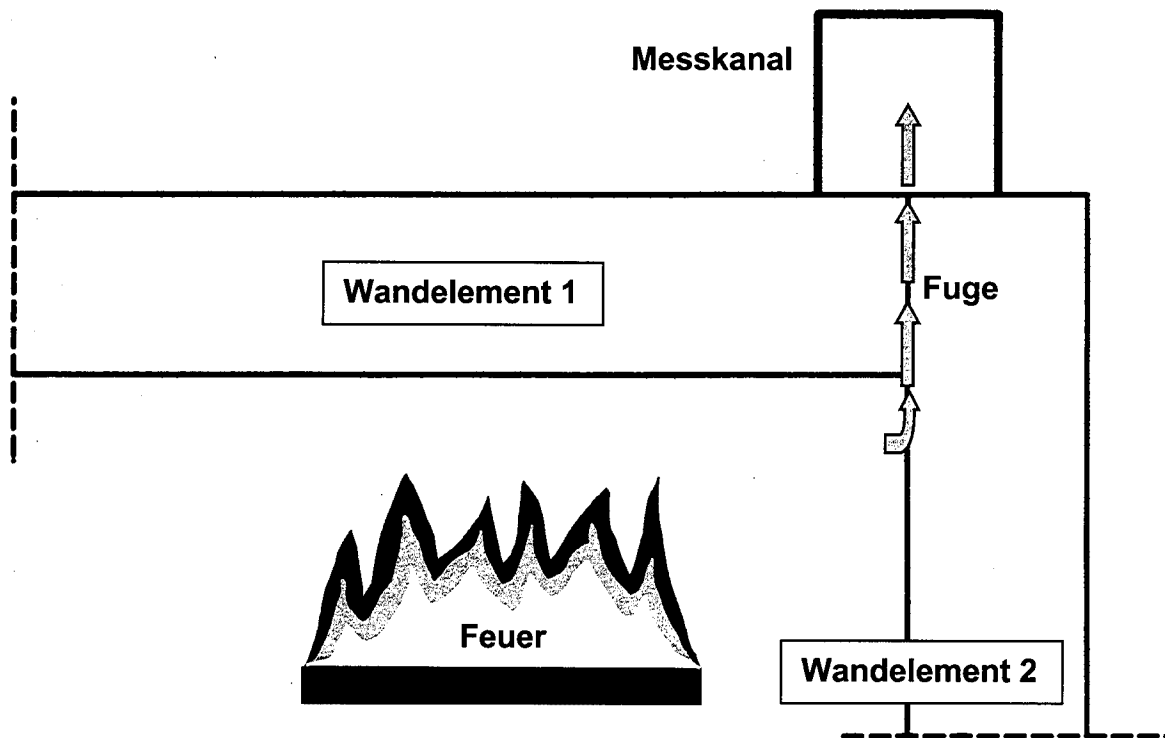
Anschluss Wand/Wand (Grundriss)
